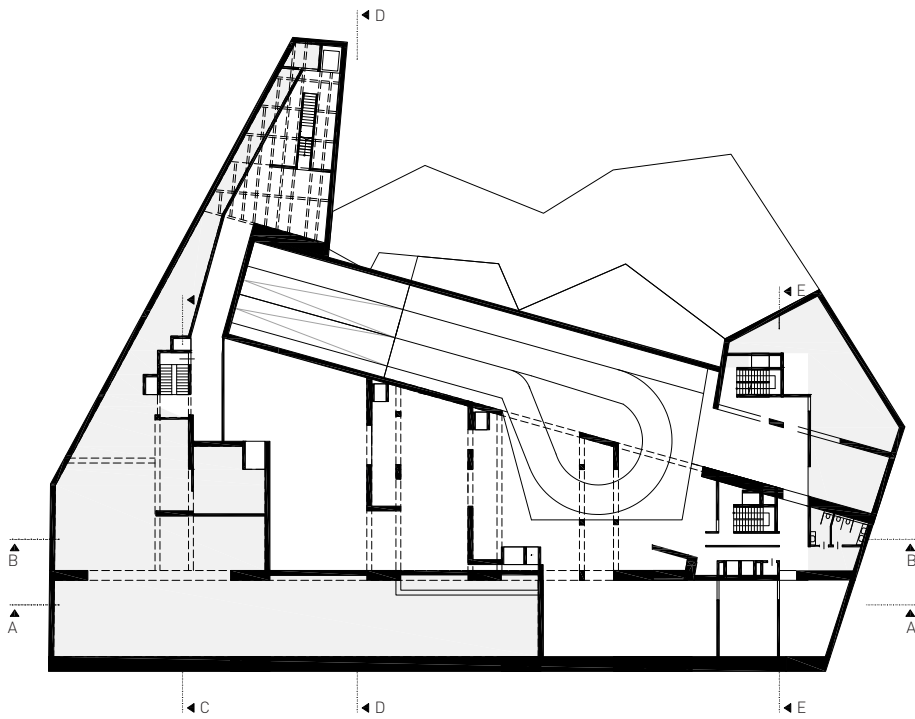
Grundriss Funktionen UG -4,35m
